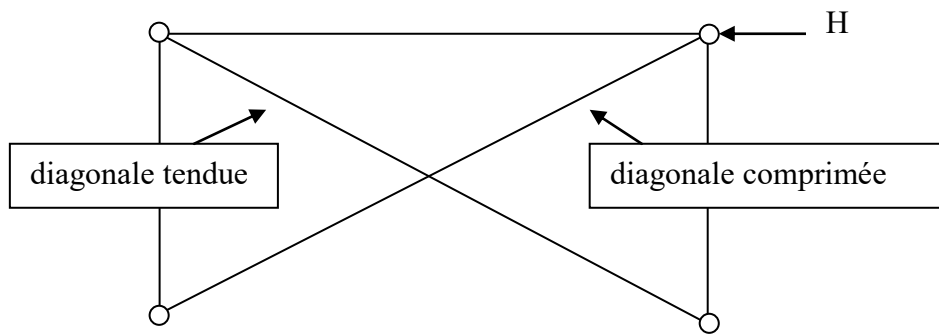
portique poteau poutre à liaison articulée et stabilisé par palée de stabilité
